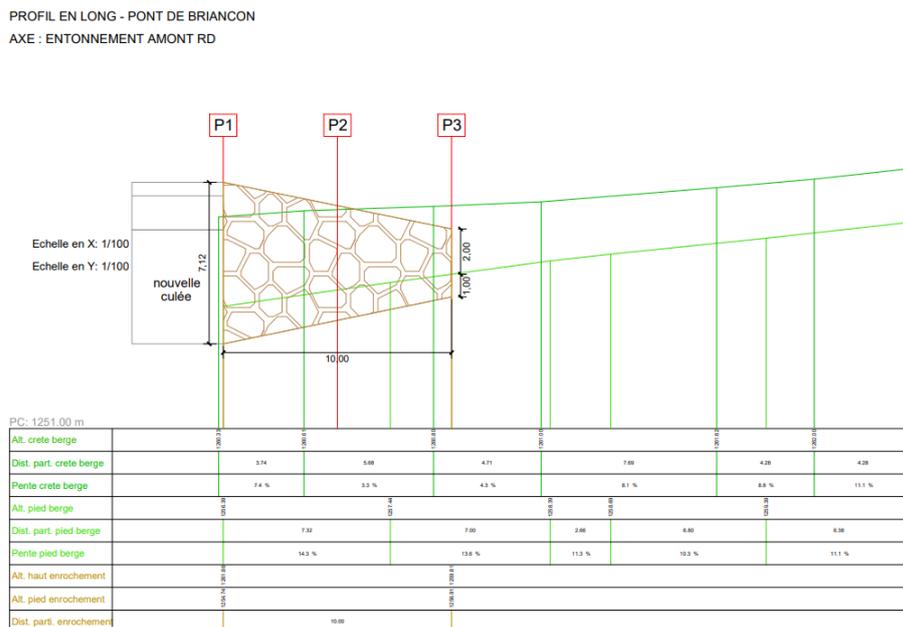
Profil en long - Pont de Briançon ; Axe : entonement amont RD
